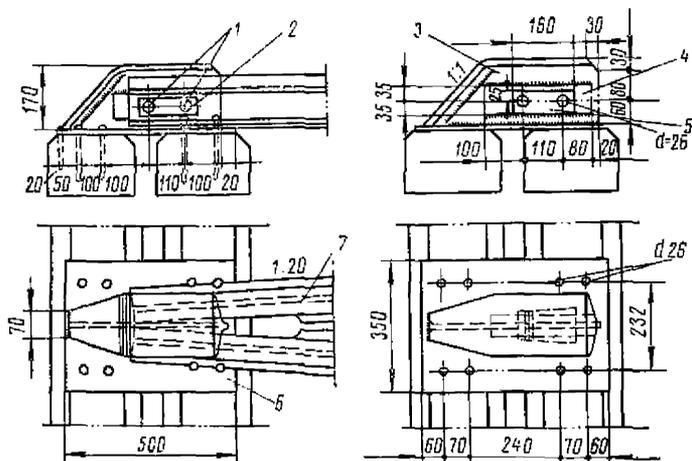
Металлический башмак, укладываемый в конце контррельсов (размеры даны для контррельсов из рельсов Р43):
